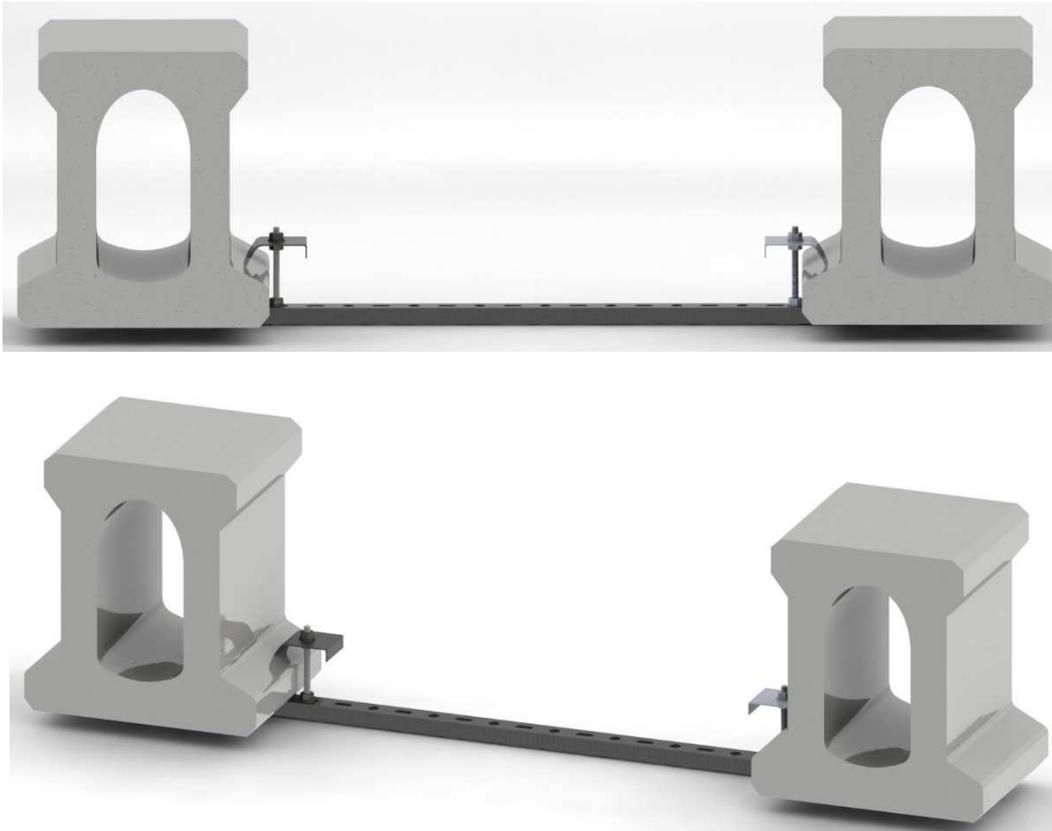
Sistema de sujeción sobre 2 perfiles de hormigón pretensado.
